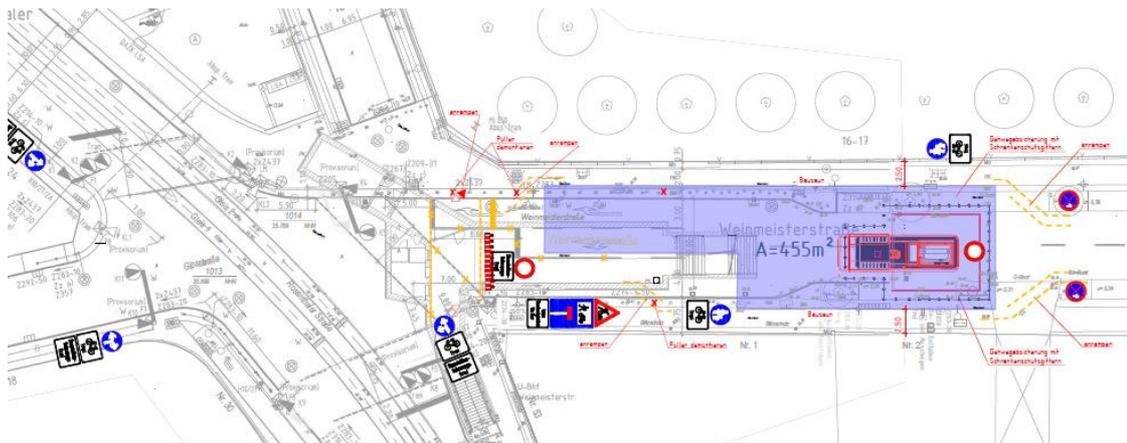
Entwurfsplanung, Lageplan Straßenbau, Auszug Plan W_PG203, LK Argus
